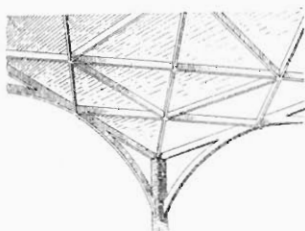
Disposition d'Épines appliquées à des toitures et planchers
